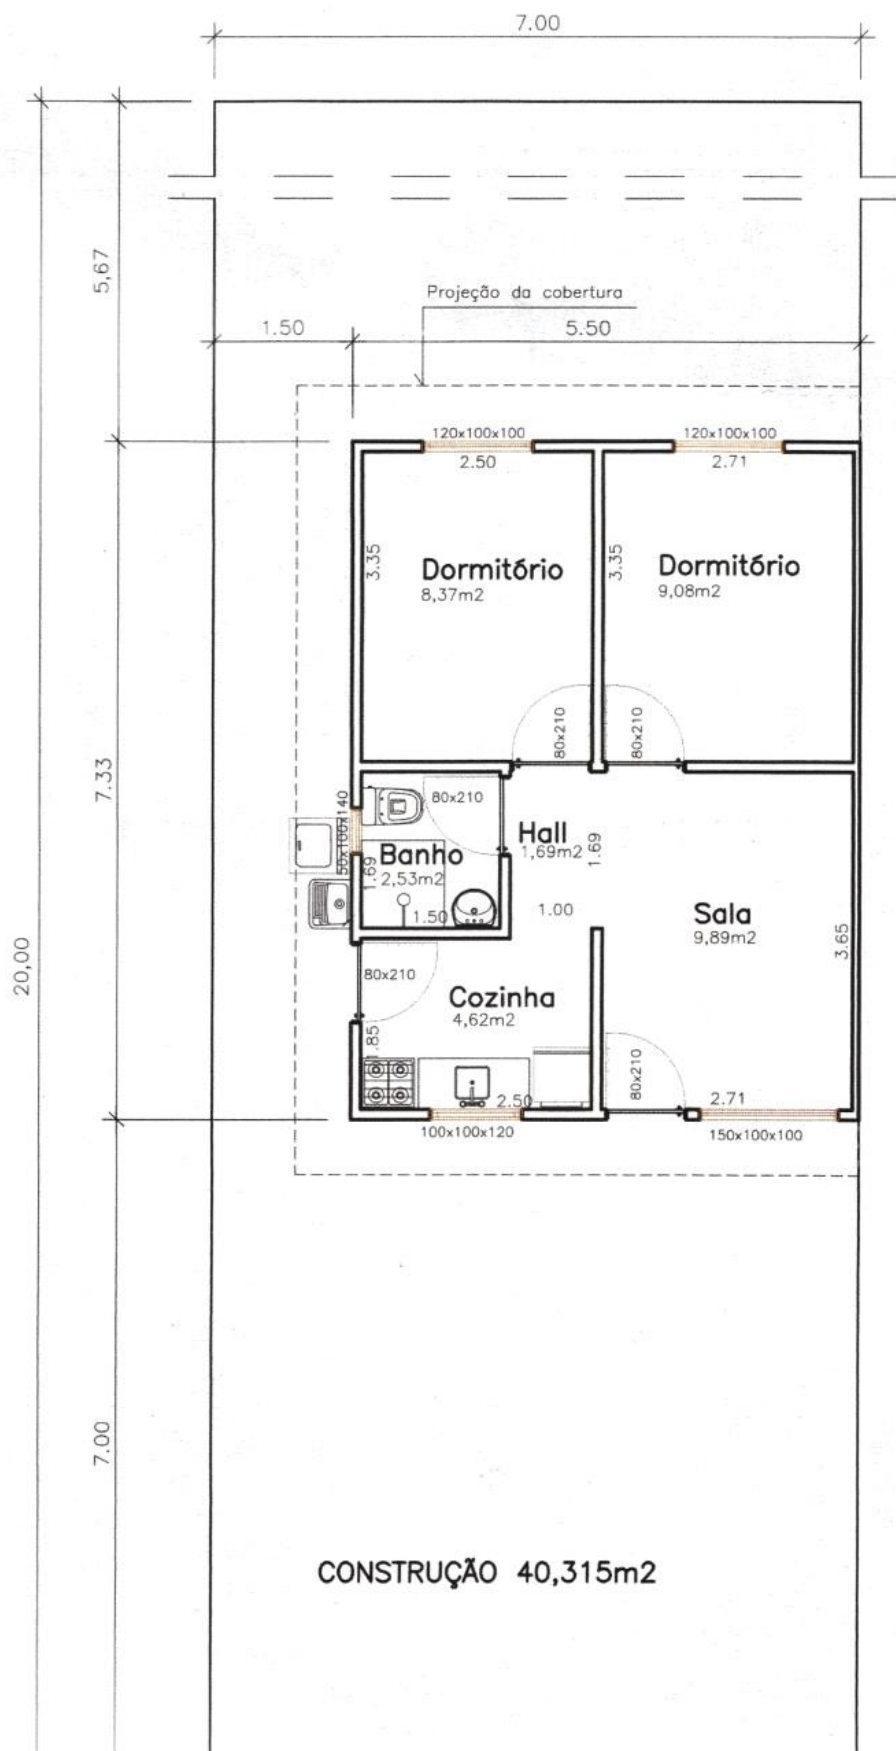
Planta baixa do conjunto estudado, sem escala - Fonte: MM empreendimentos, adaptada pela Autora, 2018;
